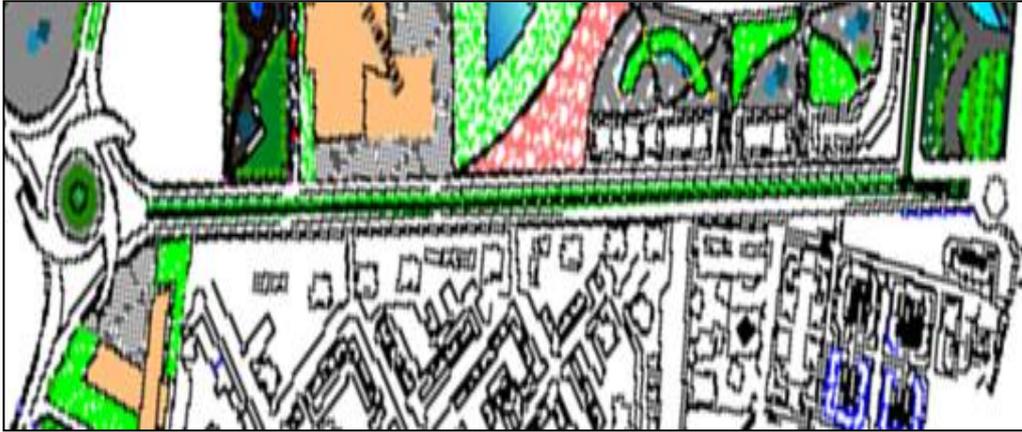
Vue en plan de la voie kada rezik après l'intervention
